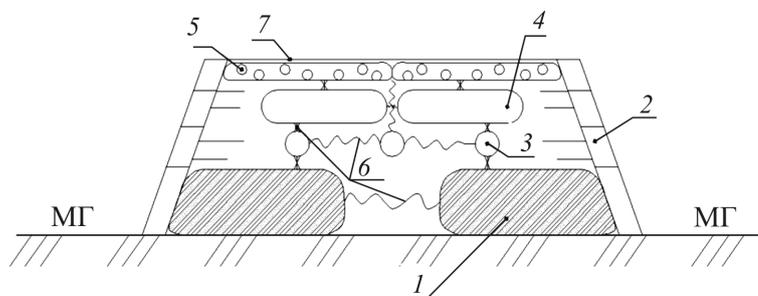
Транспортная система: 1 – нижние грунтонаполняемые оболочки; 2 – грунтоармированное покрытие; 3 – вертикальные грунтонаполняемые оболочки; 4 – верхние грунтонаполняемые оболочки; 5 – грунтонаполняемое дорожное покрытие (грунтозаполненная оболочка с окатышами); 6 – демпферное устройство; 7 – дорожный верхний слой
